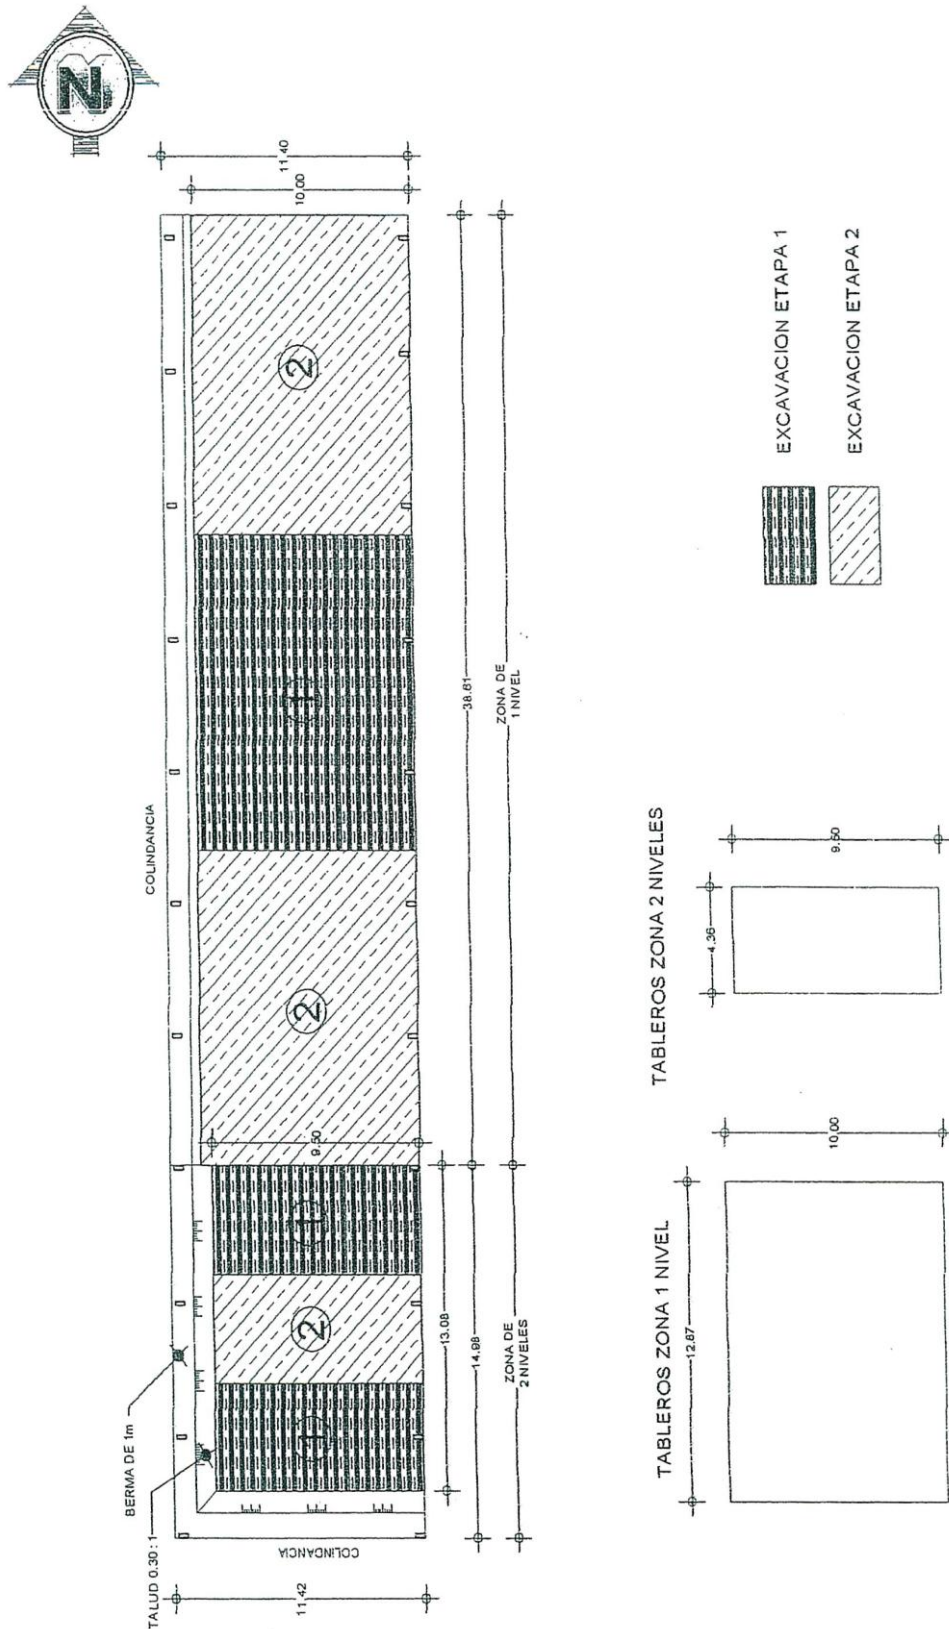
PLANTA DE ETAPAS DE EXCAVACION ESTRUCTURA III (ALMACEN)
